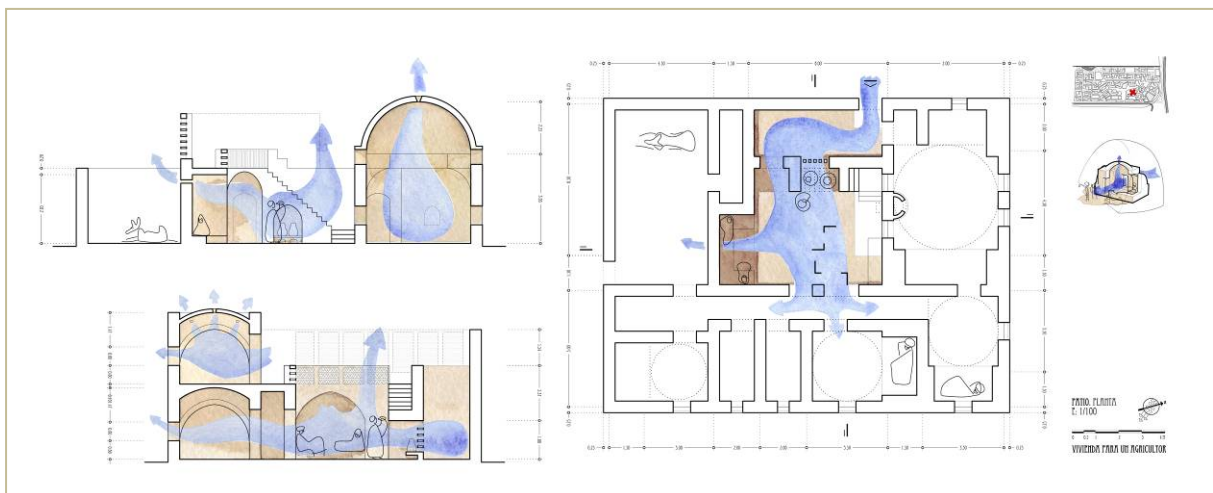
Secciones y planta de vivienda en Nueva Gourná. Redibujado por Javier Parra.
